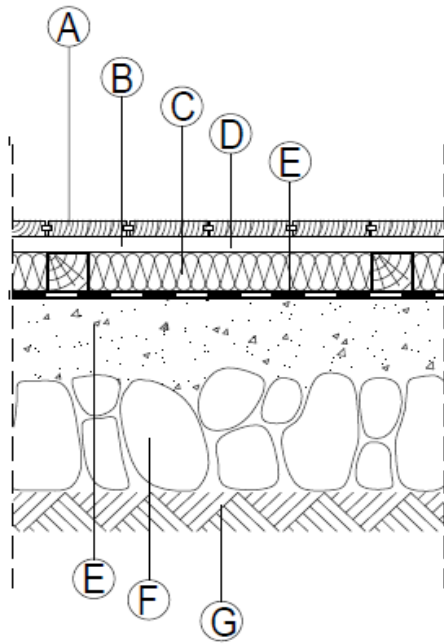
2: Döşeme Betonu Altında Bulunan Isı Yalıtım Detayı
